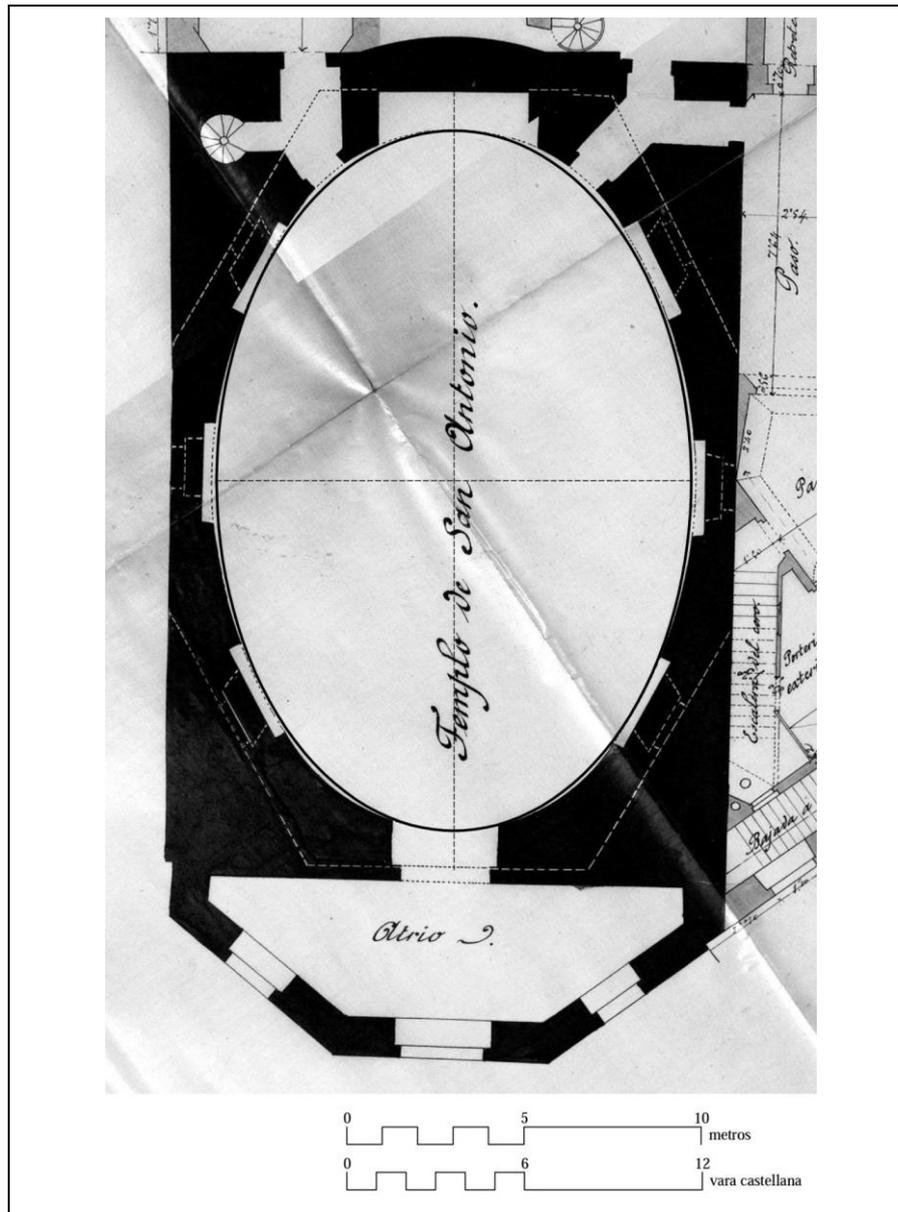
Planta obtenida sobre la Planta de Antonio Ruíz de Salces (1881).
